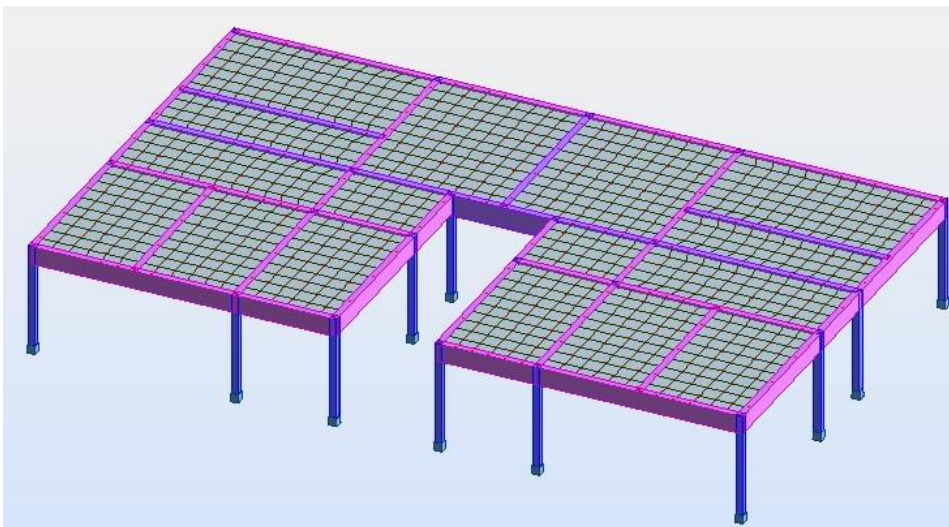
Malha de elementos finitos do piso do primeiro pavimento
